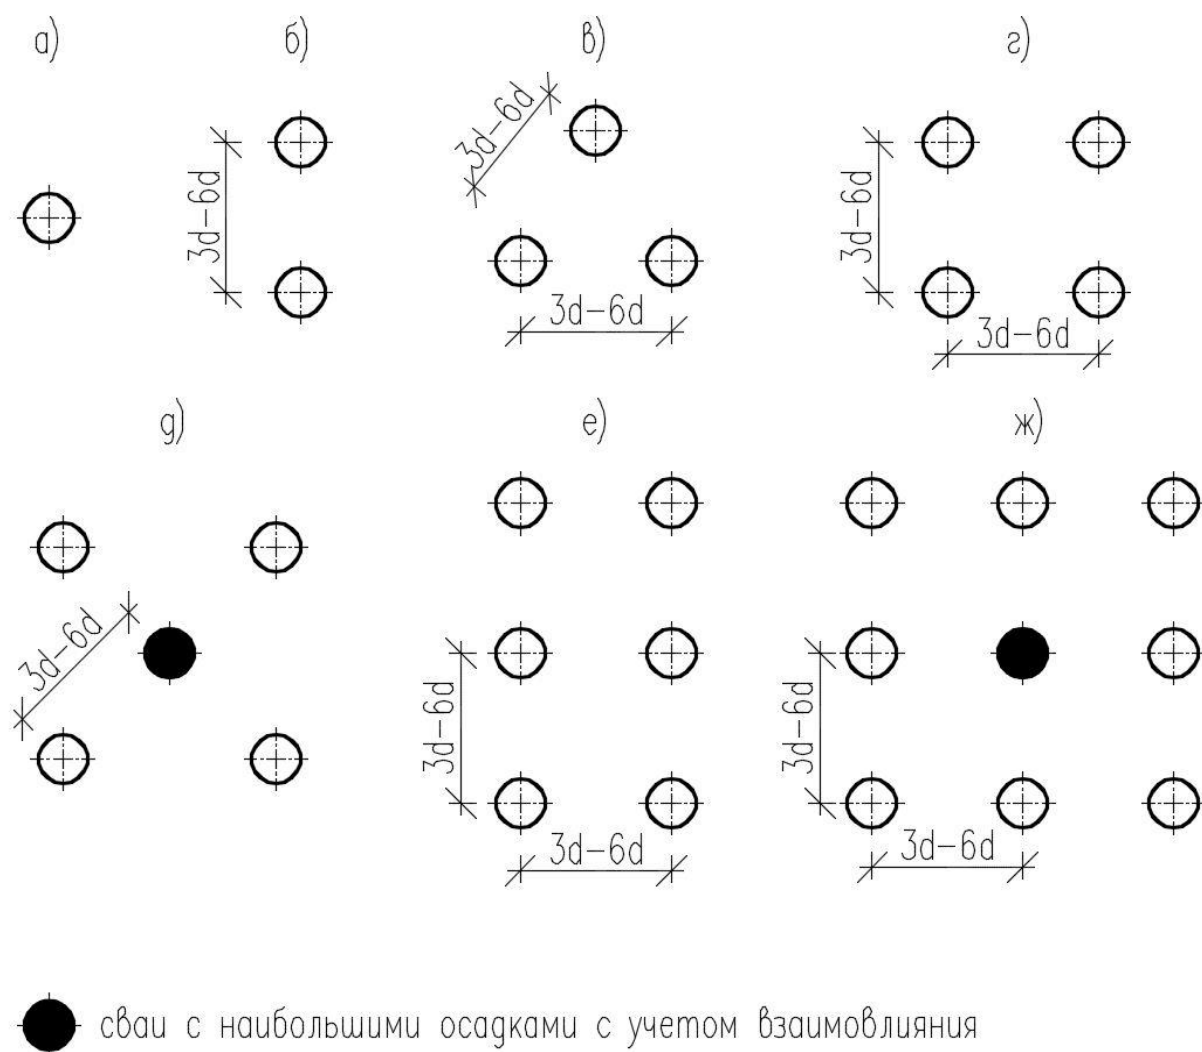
Схема расположения свай при расчете осадок:
